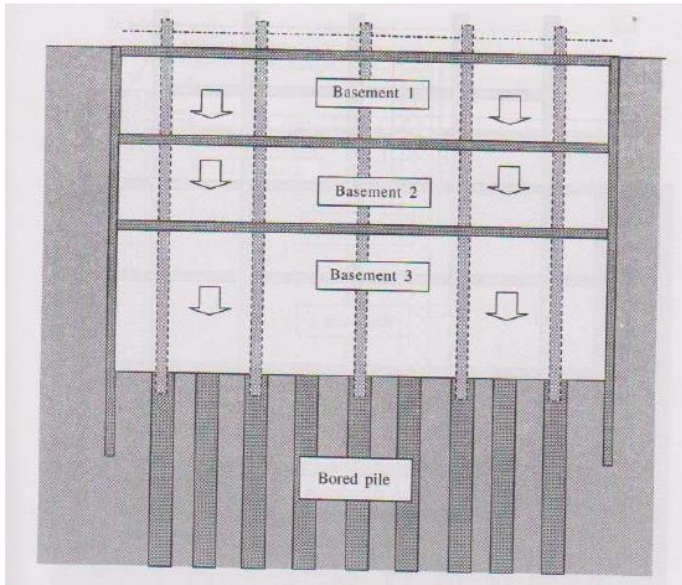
Pengecoran lantai basemen 1 dan 2
